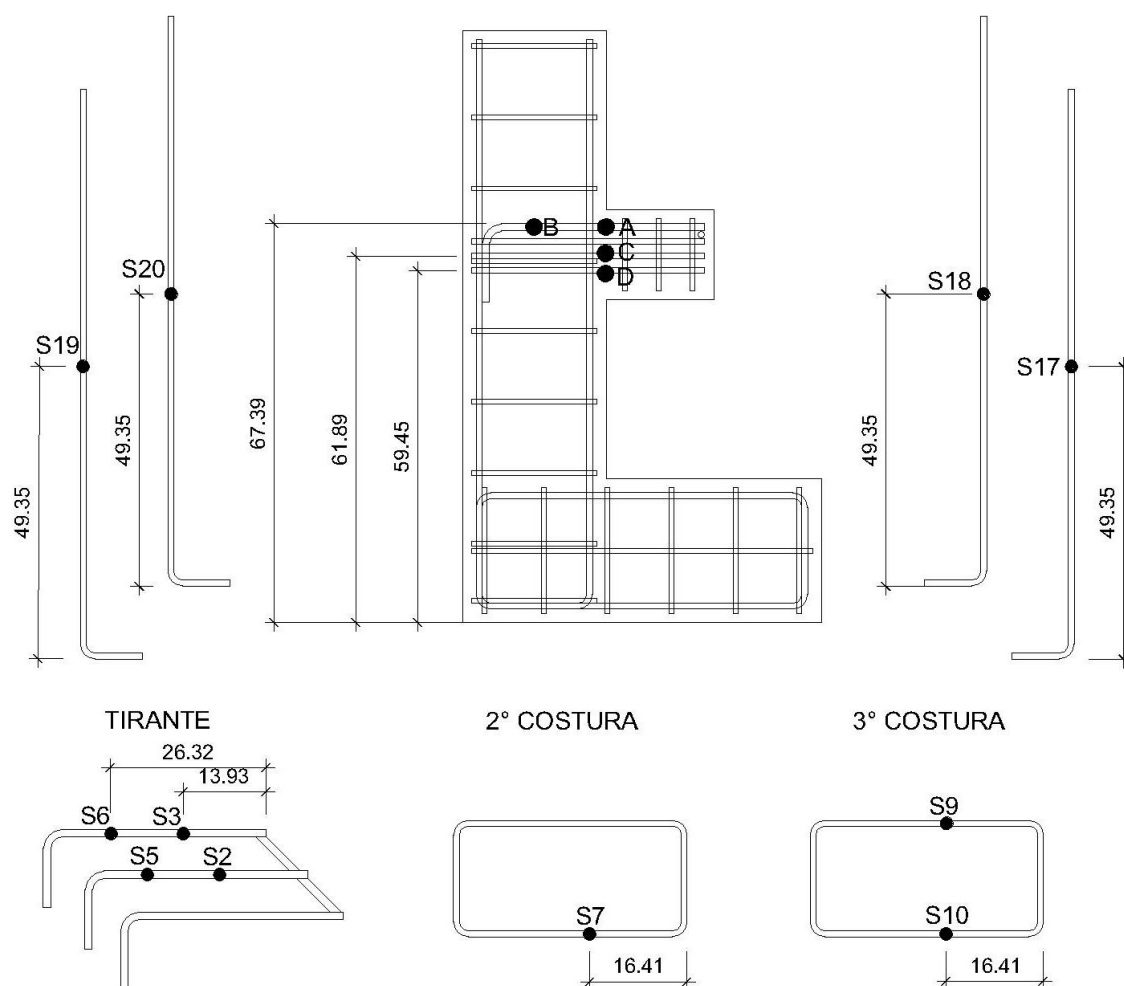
Extensômetros na armadura do modelo P2M1MON
